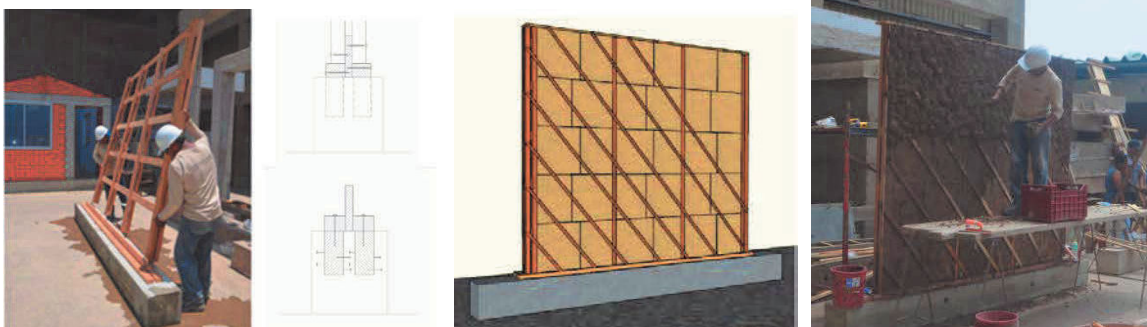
Sistema constructivo mixto propuesto (Archivo de proyecto, 2018).
